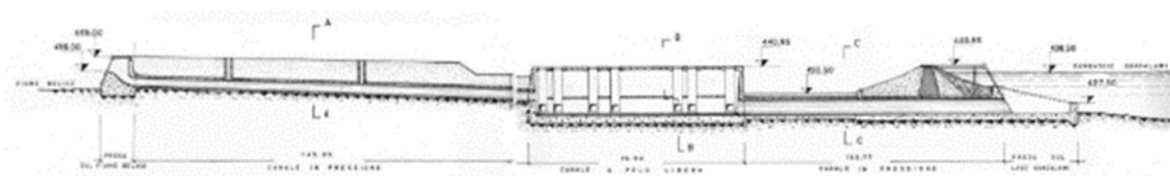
Profilo longitudinale canale di presa e restituzione (ENEL, 2013)
